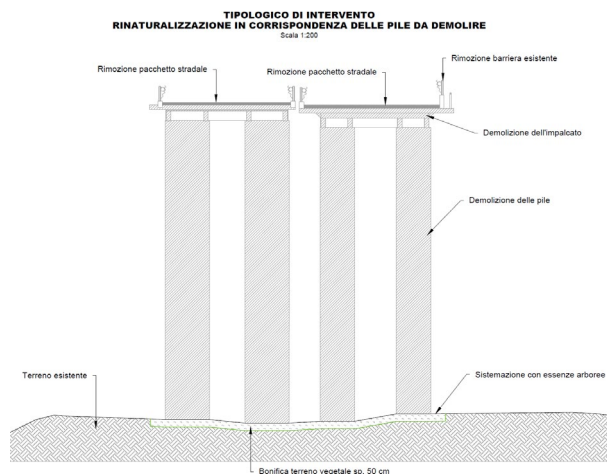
Sezione tipo rinaturalizzazione in corrispondenza delle pile da demolire
